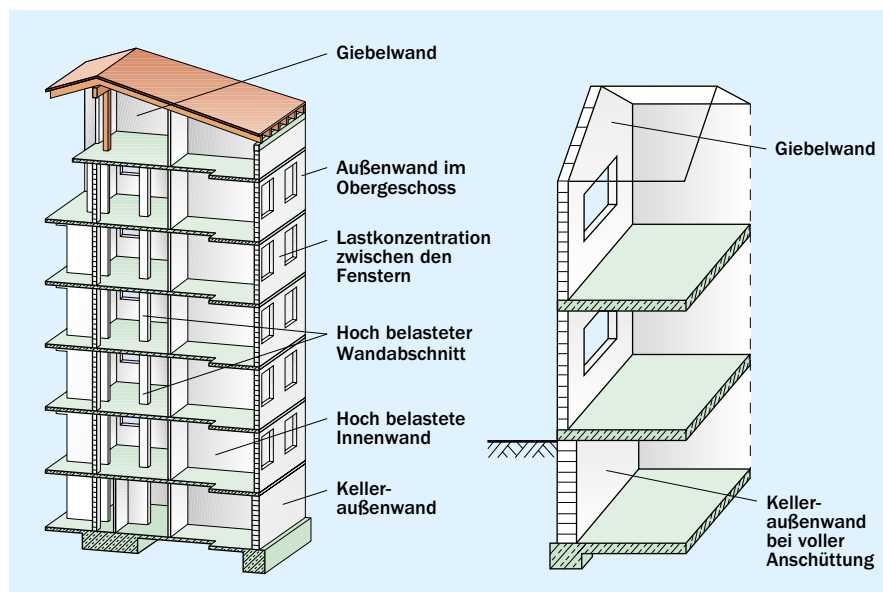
Wichtige Bauteile und wesentliche Nachweisstellen im Mauerwerksbau
